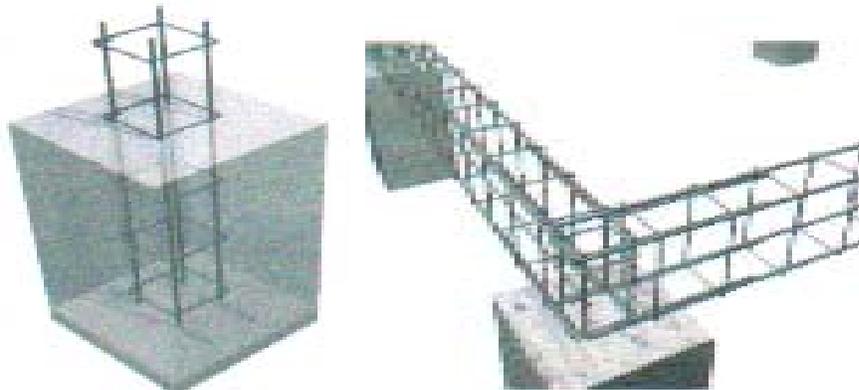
Cimentación de pilas cuadradas de concreto y sobre de ellas el armado de las dalas.
